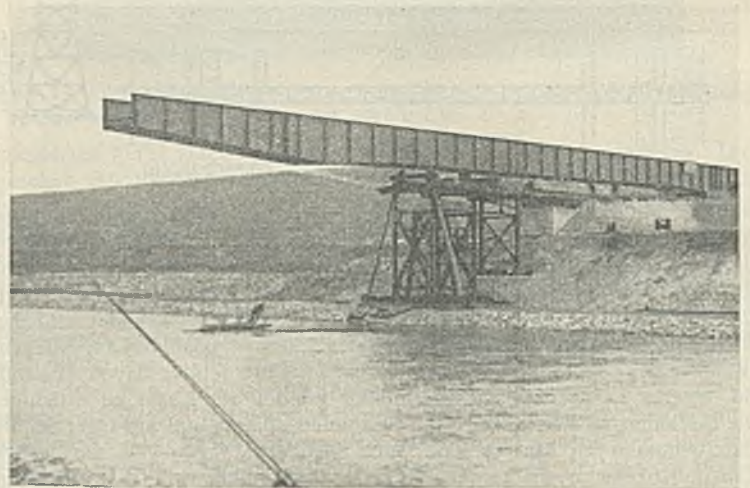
Die Brücke ist fast bis zur Hälfte vorgefahren.
